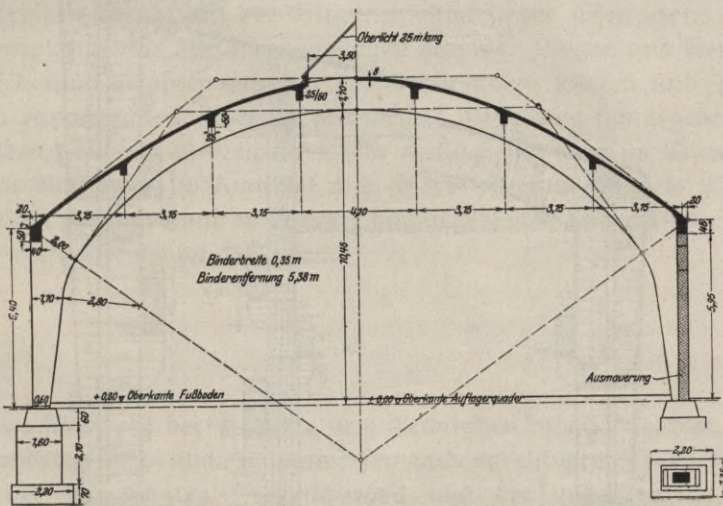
Hallenbinder. Dampfägewerk Koch, Eislingen.
